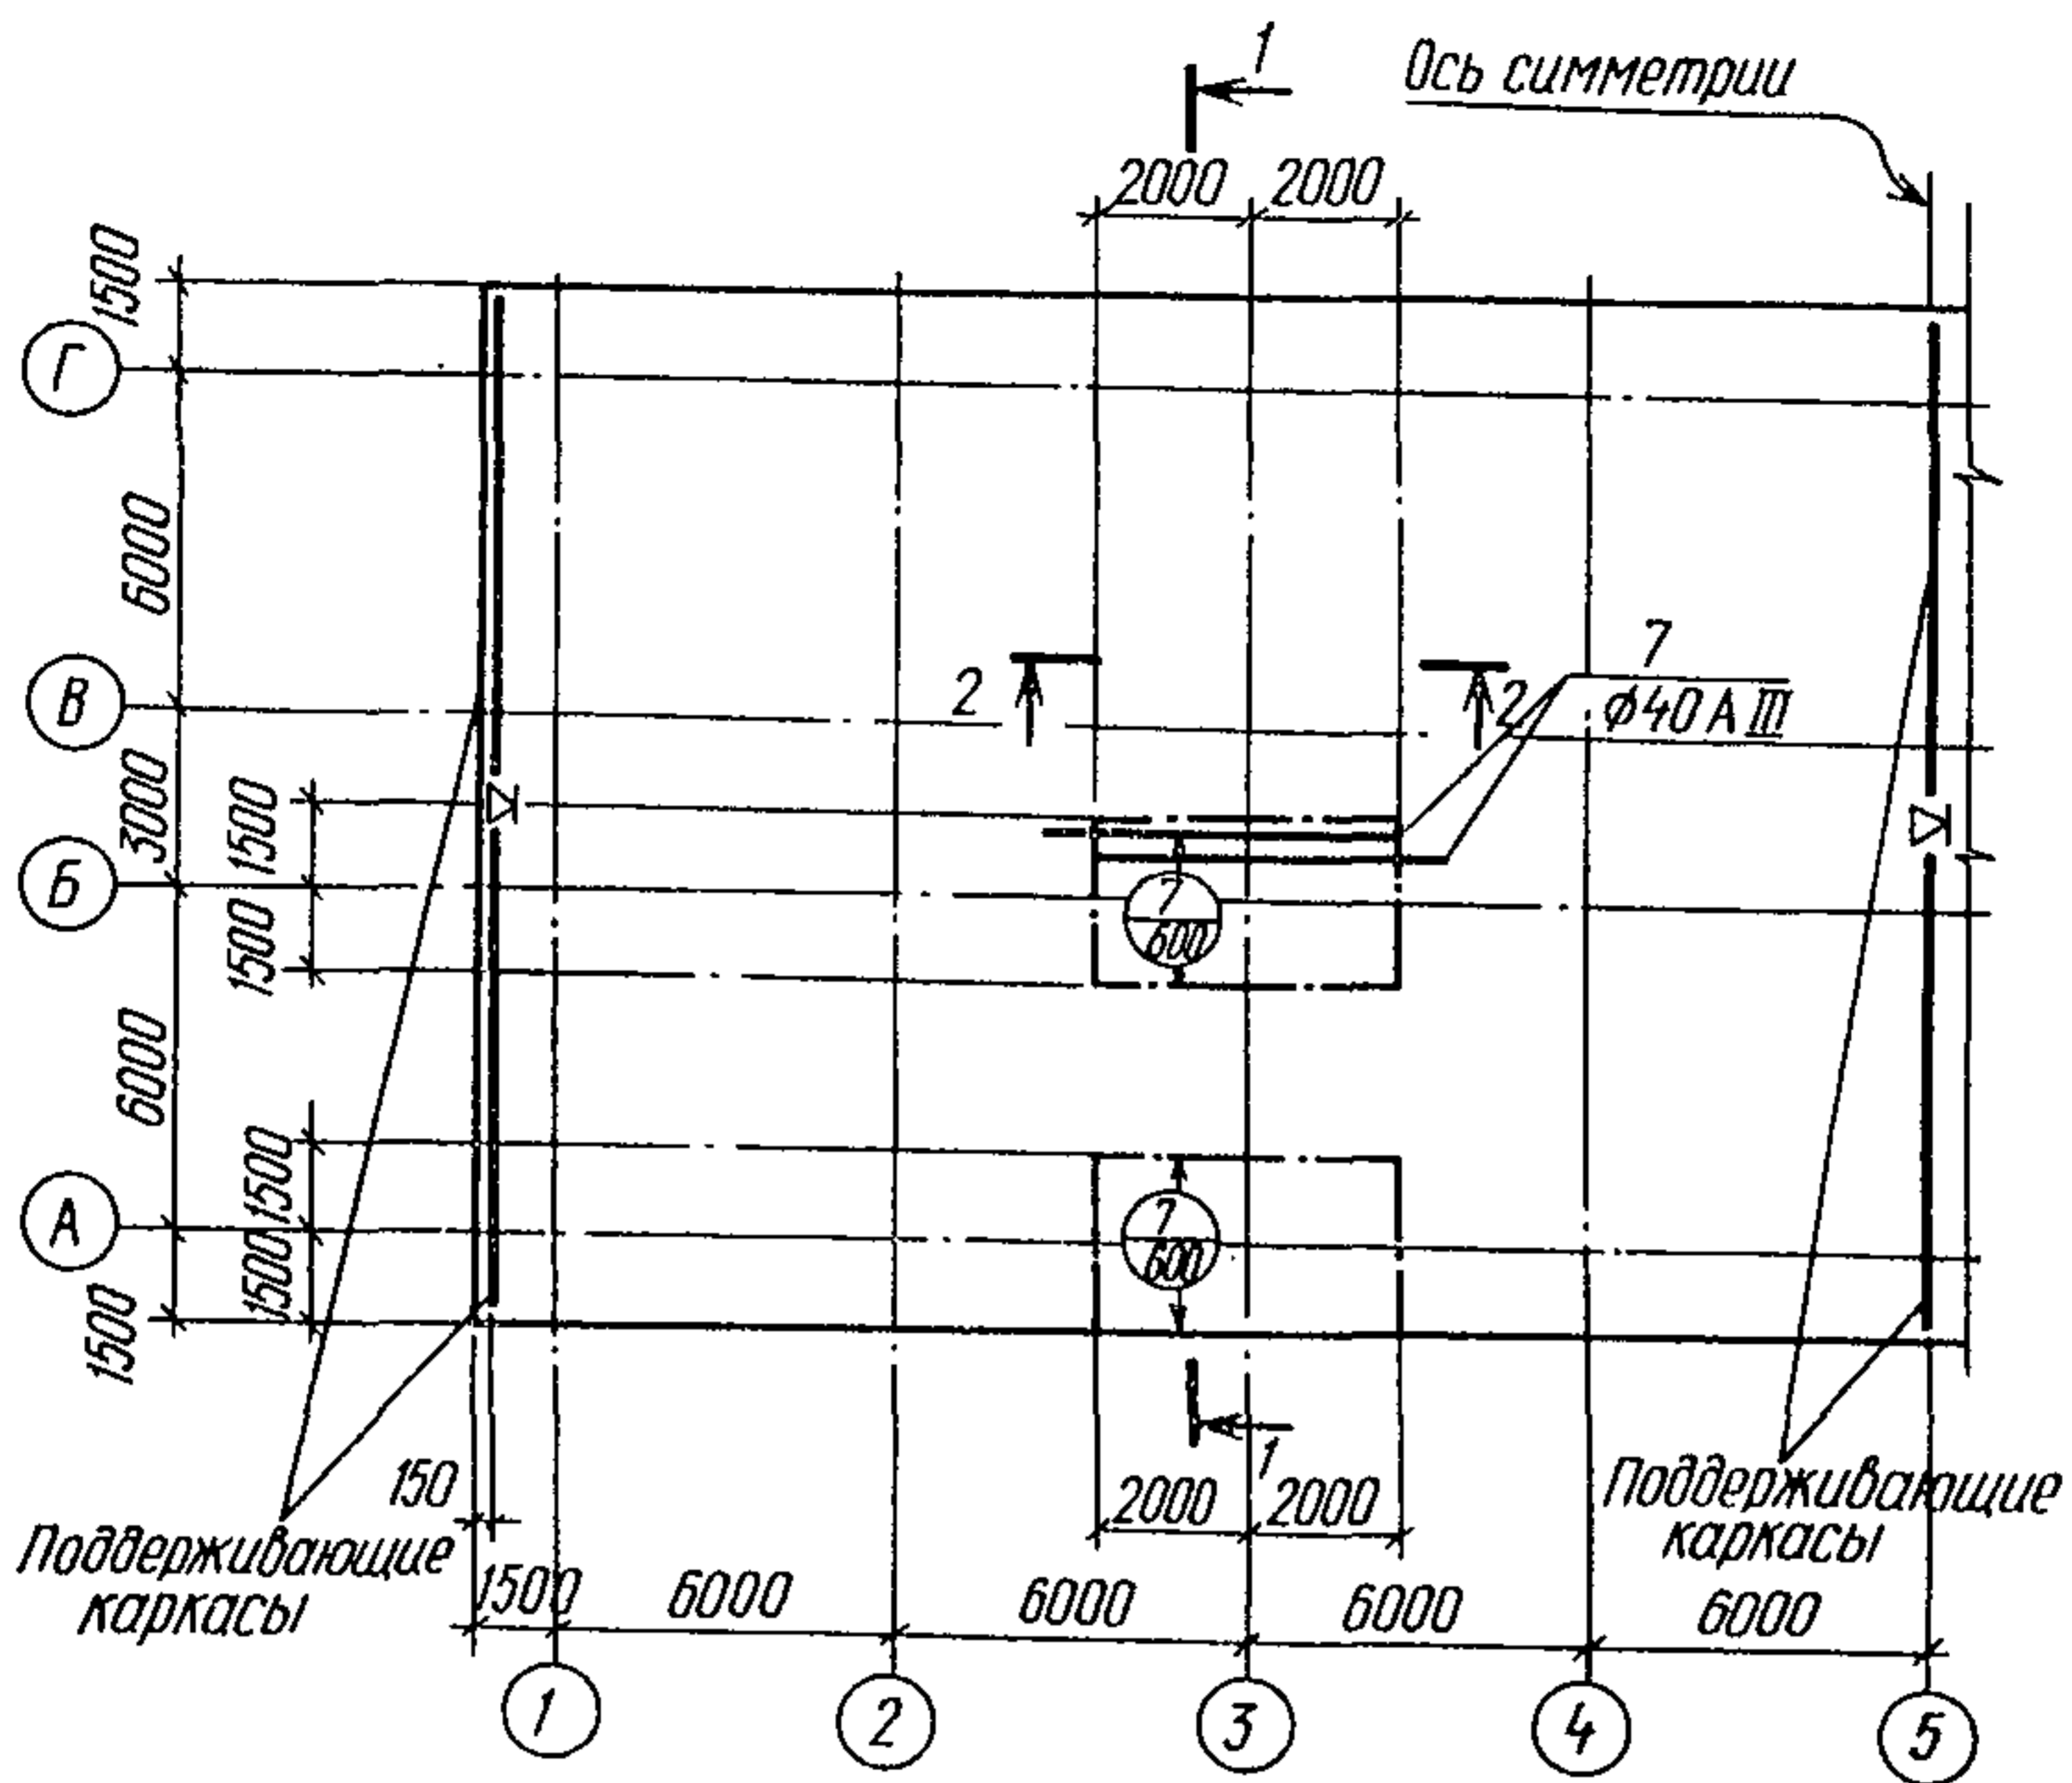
План раскладки арматуры четвертого слоя нижней зоны и поддерживающих каркасов
